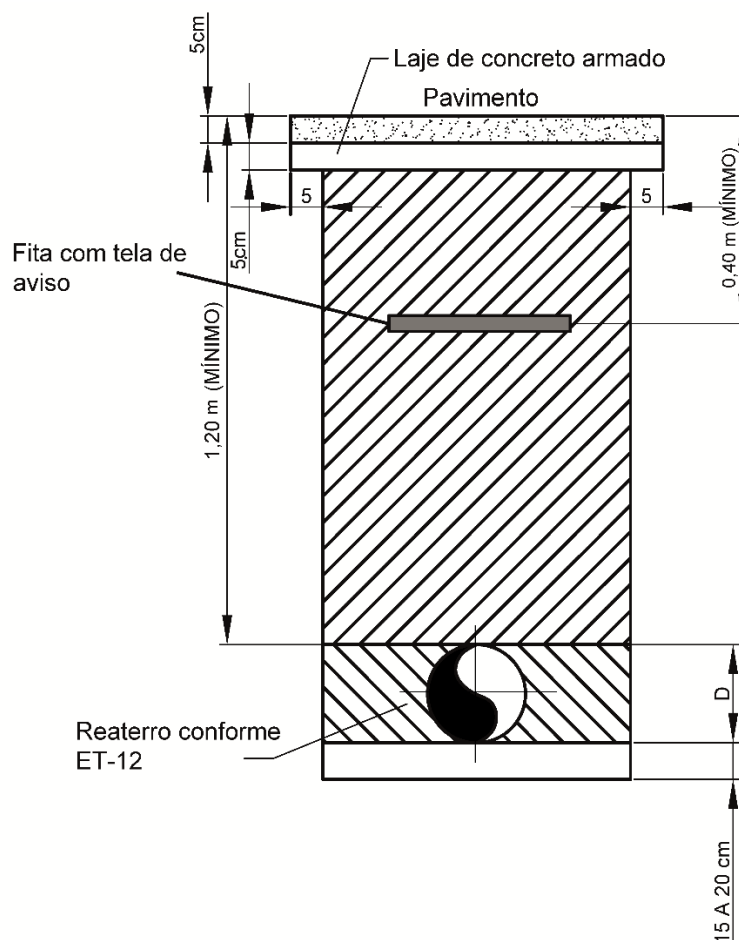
Detalhe da tubulação na vala, com fita/faixa de aviso e laje de concreto.
